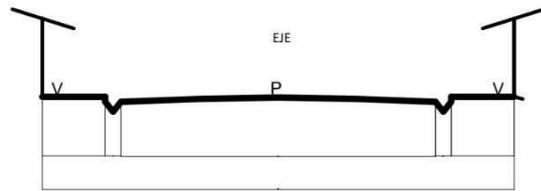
Vía de Evitamiento (Sección 1)
